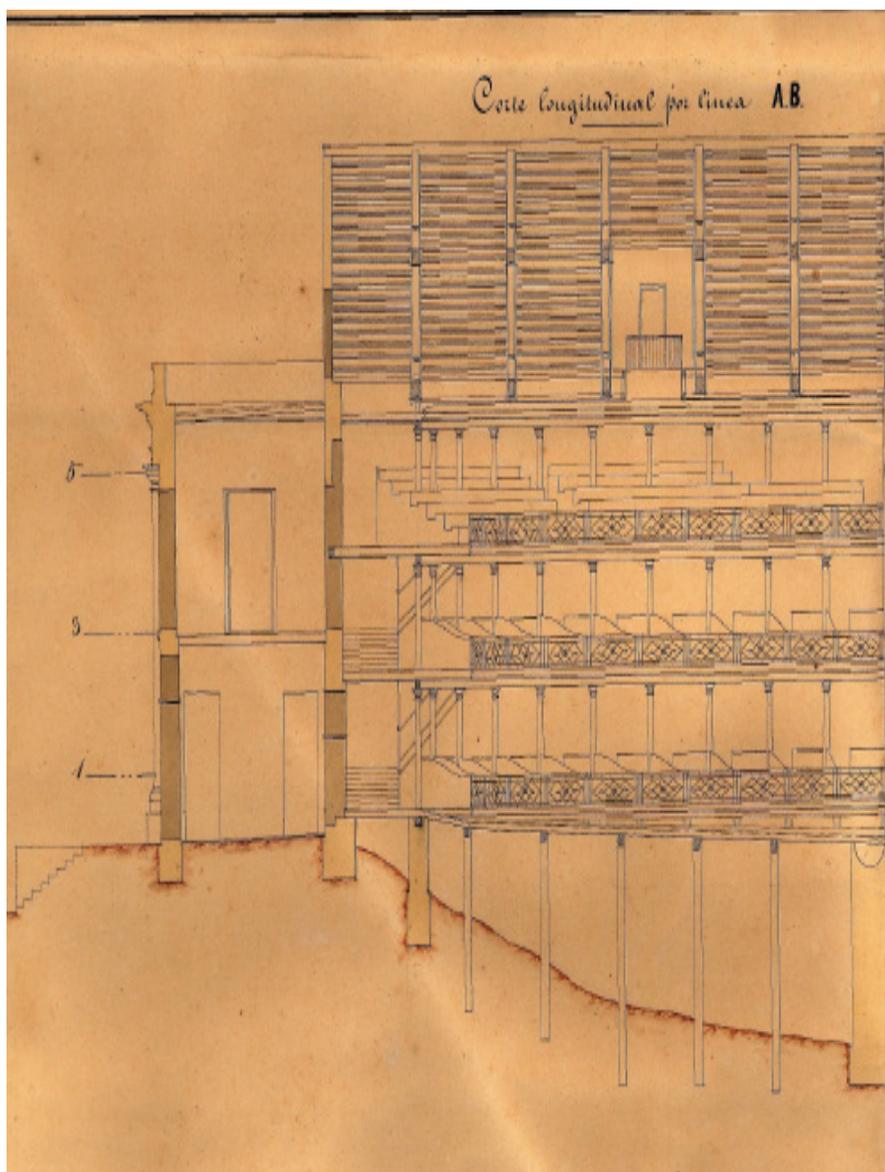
Detalle. Corte longitudinal línea AB (AHMM, Cuba 257-01)
